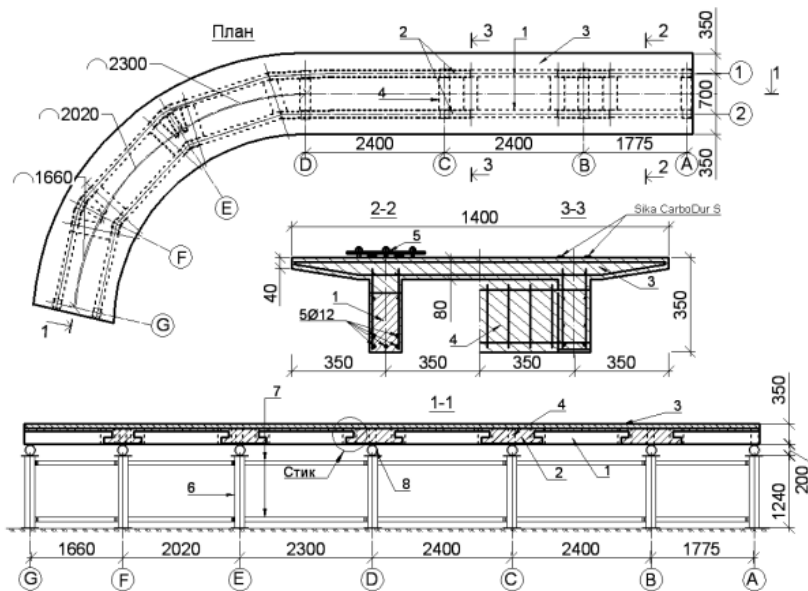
План і розрізи моделей двобалкових збірно-монолітних нерозрізних залізобетонних конструкцій прогонових будов мостів: 1 – прогонові збірні залізобетонні балки; 2 – над опорні монолітні балки; 3- монолітна плита; 4- діафрагма; 5- анкер для кріплення неметалевої кінців стрічкової арматури Sika CarboDur S212 шляхом притискання до бетону; 6- металеві опори стенду; 7 – металеві зв’язки опор стенду, 8- кільцеві динамометри
